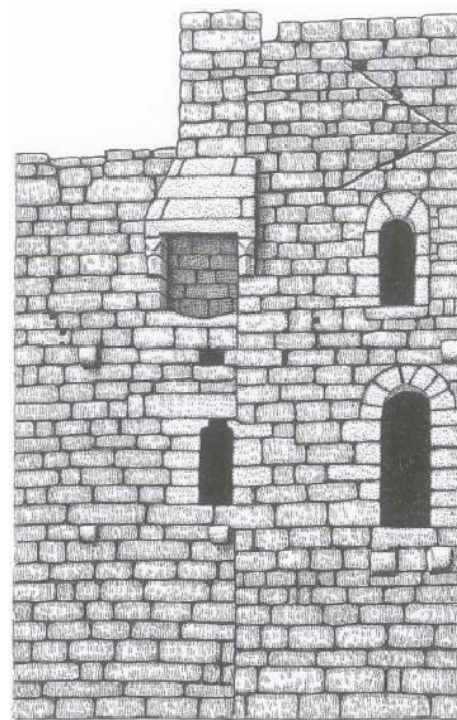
Chimenea y ménsulas de apoyo de un forjado de madera a nivel de planta segunda anexa al muro perimetral de la fachada sur en el castillo. Foto del autor, 2015.
